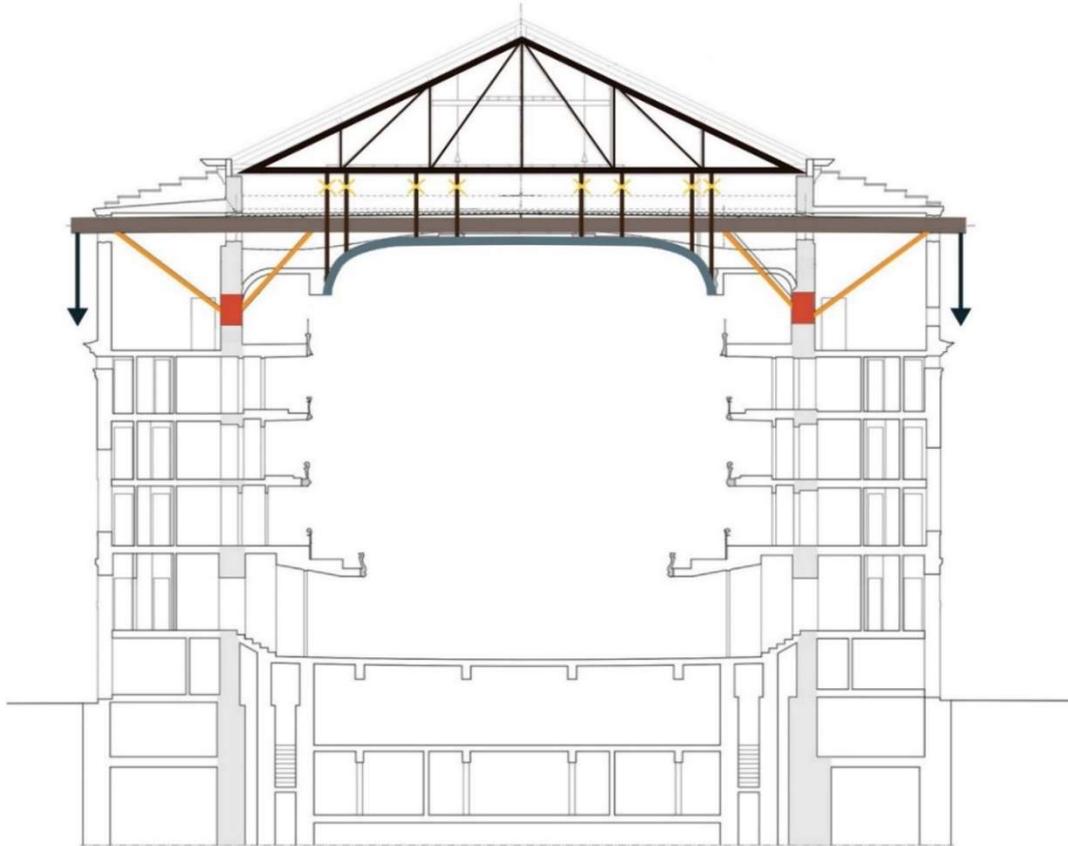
Principe pour transfert du plafond de la structure existante à la nouvelle structure (Greisch, 2013)
